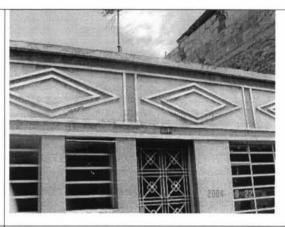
Deterioro leve en elementos no estructurales de fachada.
